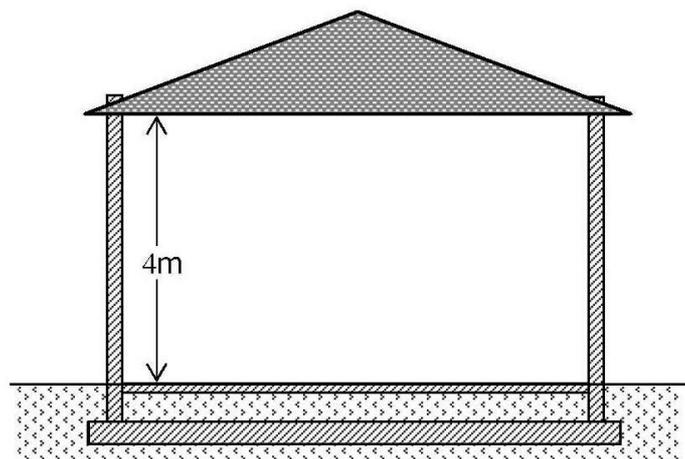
Exemple d'un bâtiment de type 3 : ERP
